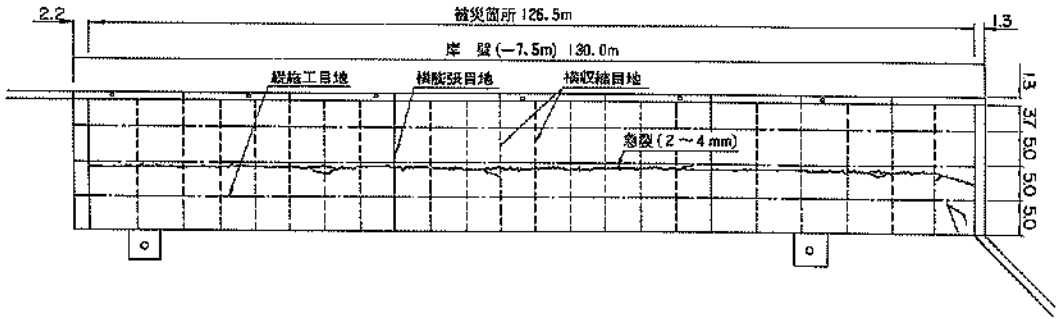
被災状況平面図 (浦河港, 岸壁(-7.5m))
